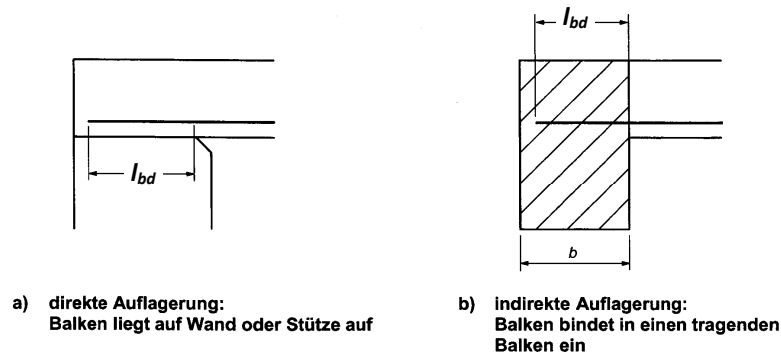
Verankerung der unteren Bewehrung an Endauflagern
